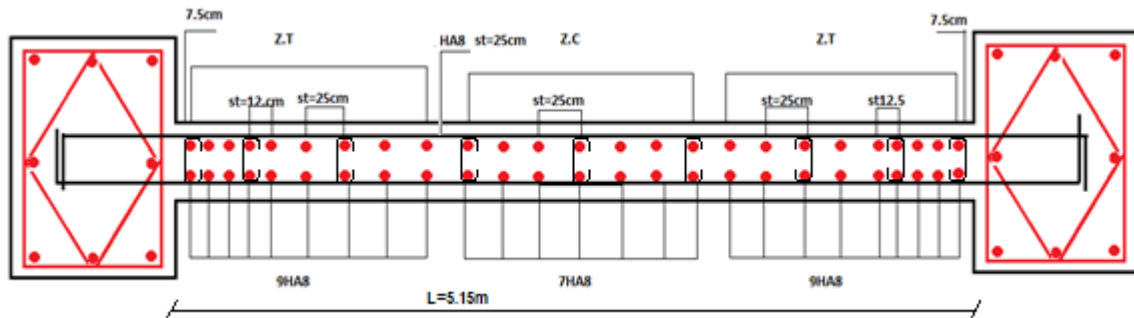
Schéma de ferrailage du voile Vx1 (niveau RDC).
